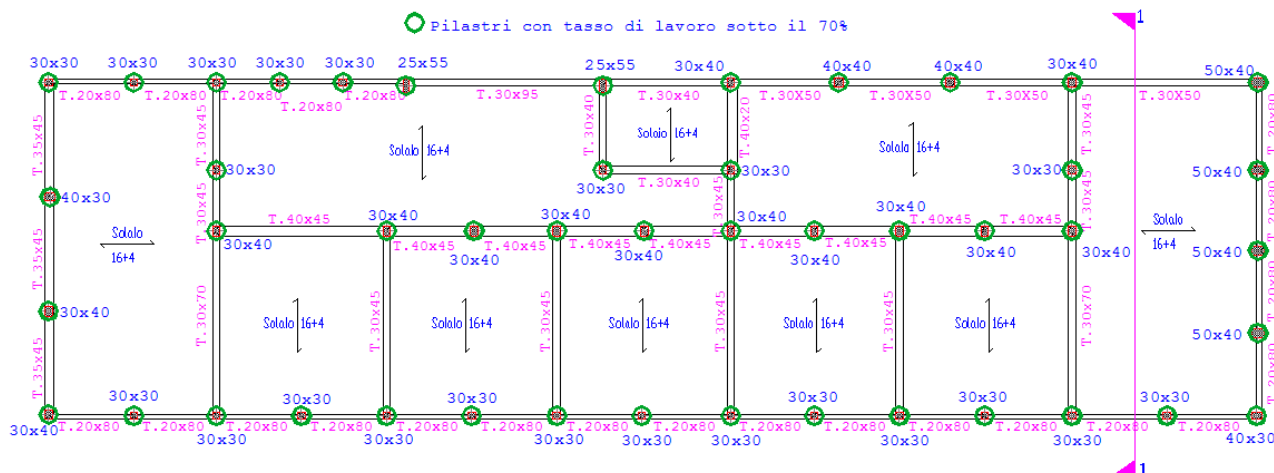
Pilastrini al piano secondo con tasso di lavoro inferiore al 70%
